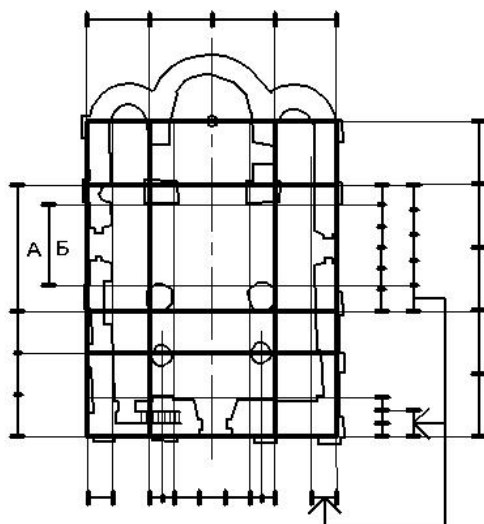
Разбивка плана на строительной площадке и определение дополнительных размеров.
